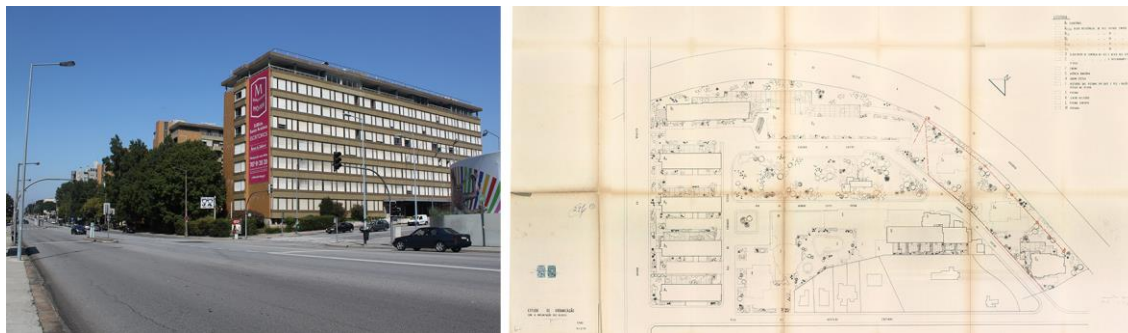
Vista desde Avenida de Boavista (©autoras, 2014)
